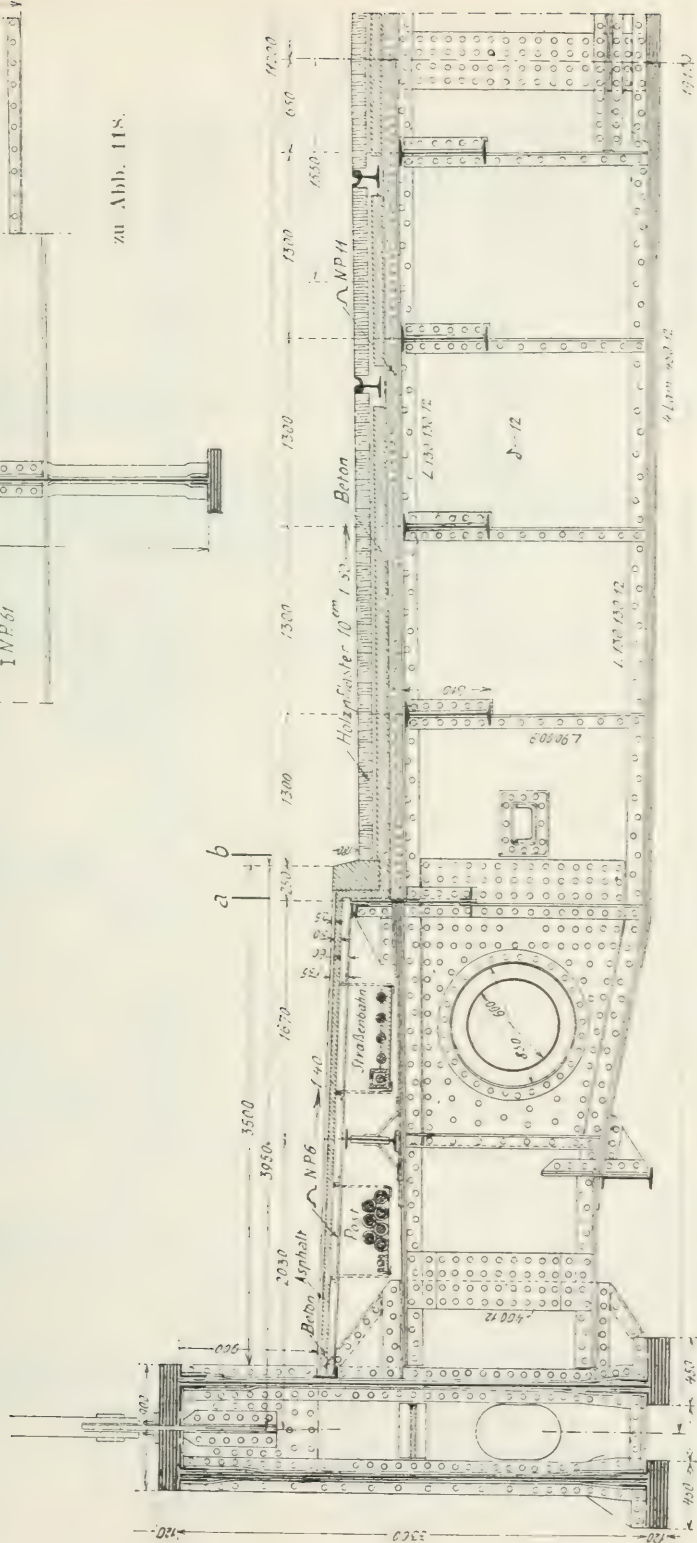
Querschnitt der Rhein-Straßenbrücke in Köln.
